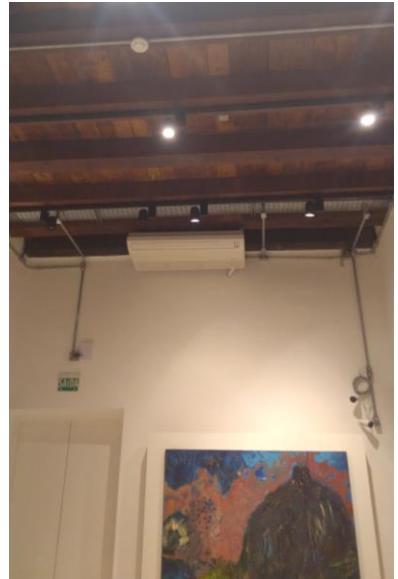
Ar-condicionado fixado na parede da circulação do segundo pavimento
